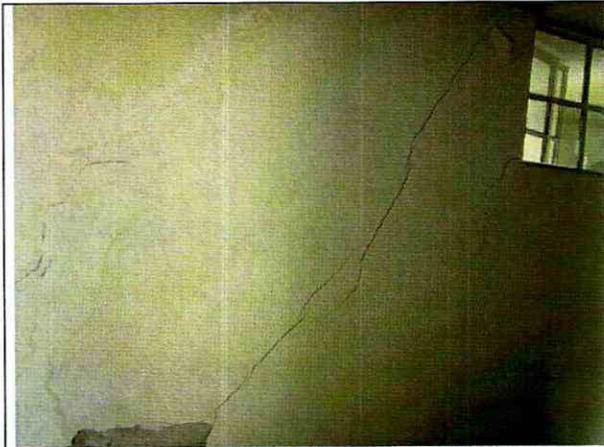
Agrietamiento diagonal en muro de tercer piso.
